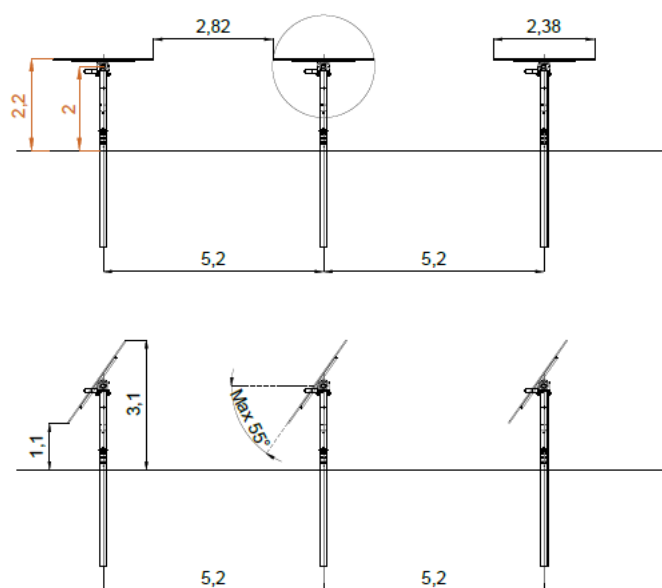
Schéma de la structure sur tracker (coupe Est-Ouest)
